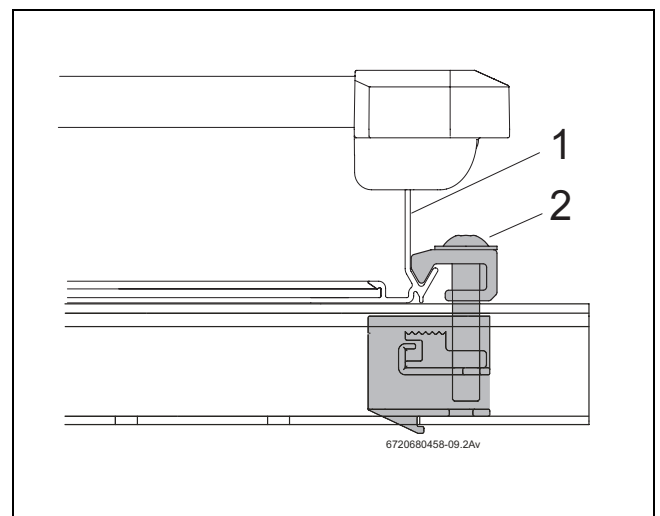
Пригвинчений односторонній натяжний пристрій для колектора
